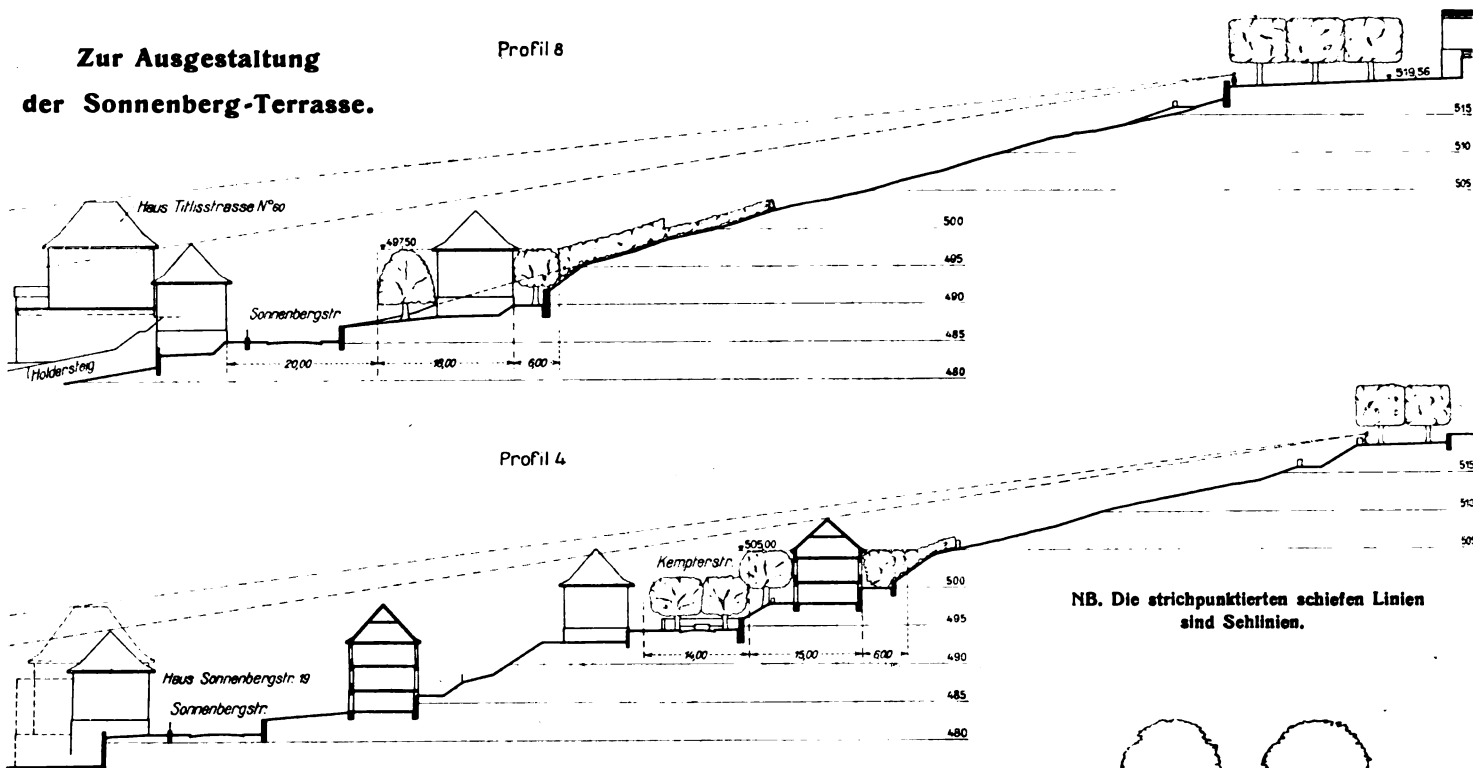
Profile 4 und 8 zum Lageplan in Abb. 2. — Massstab 1:1000.
